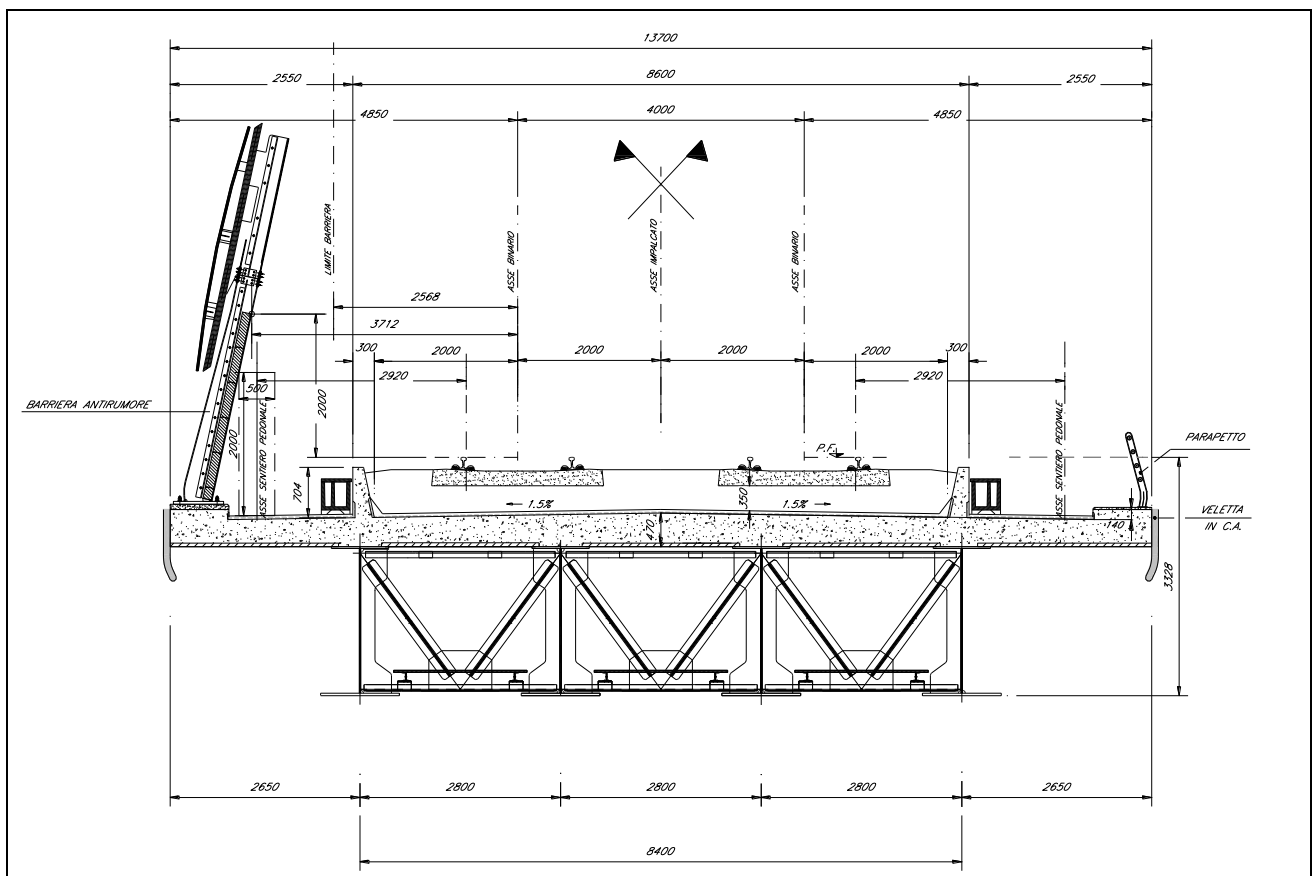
Sezione tipo impalcato misto acciaio-calcestruzzo. L=34.00m
